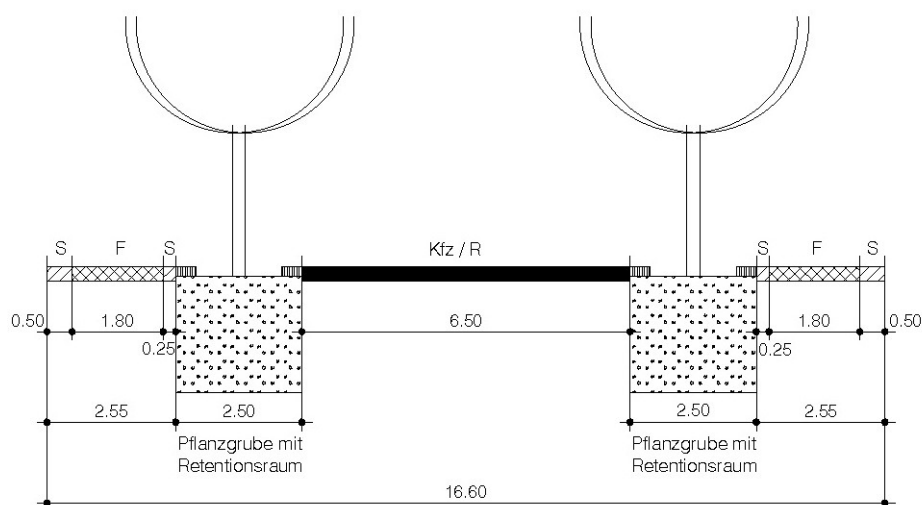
empfohlener Straßenquerschnitt für die Planstraße „A“
